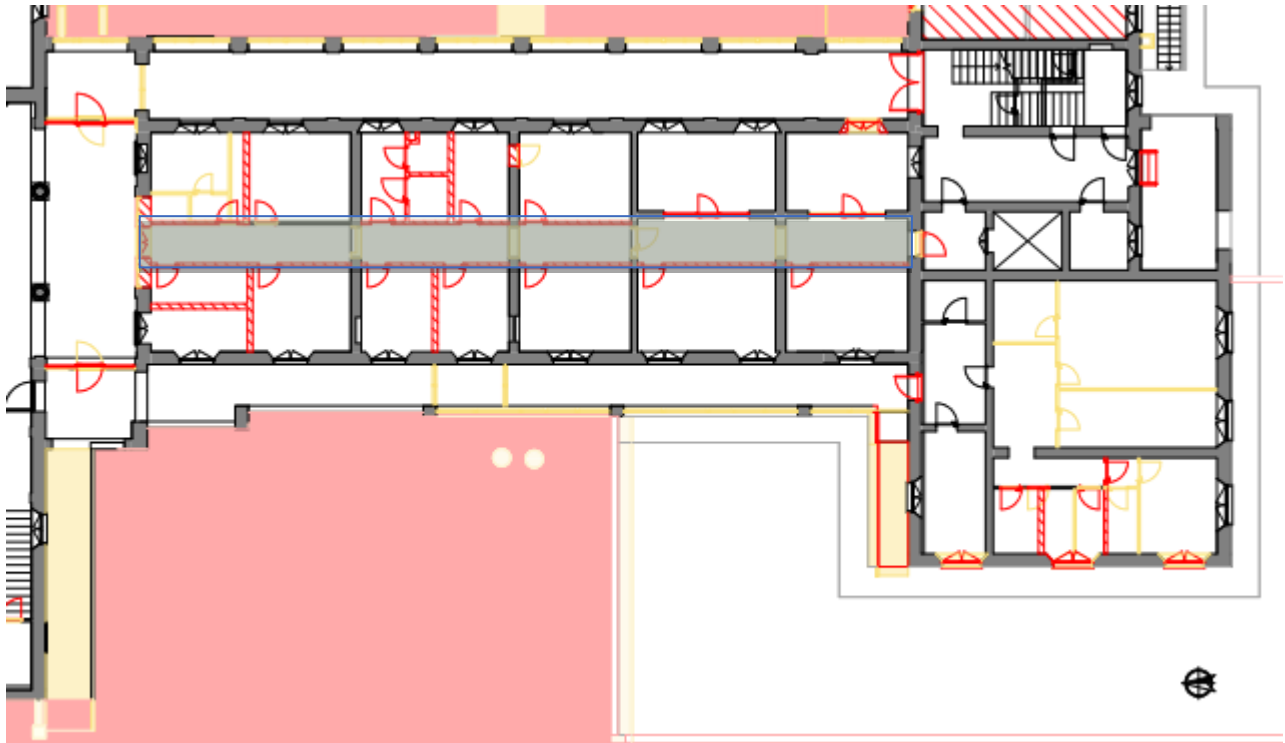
Interventi murari previsti al piano terra (zona centrale e sud)
